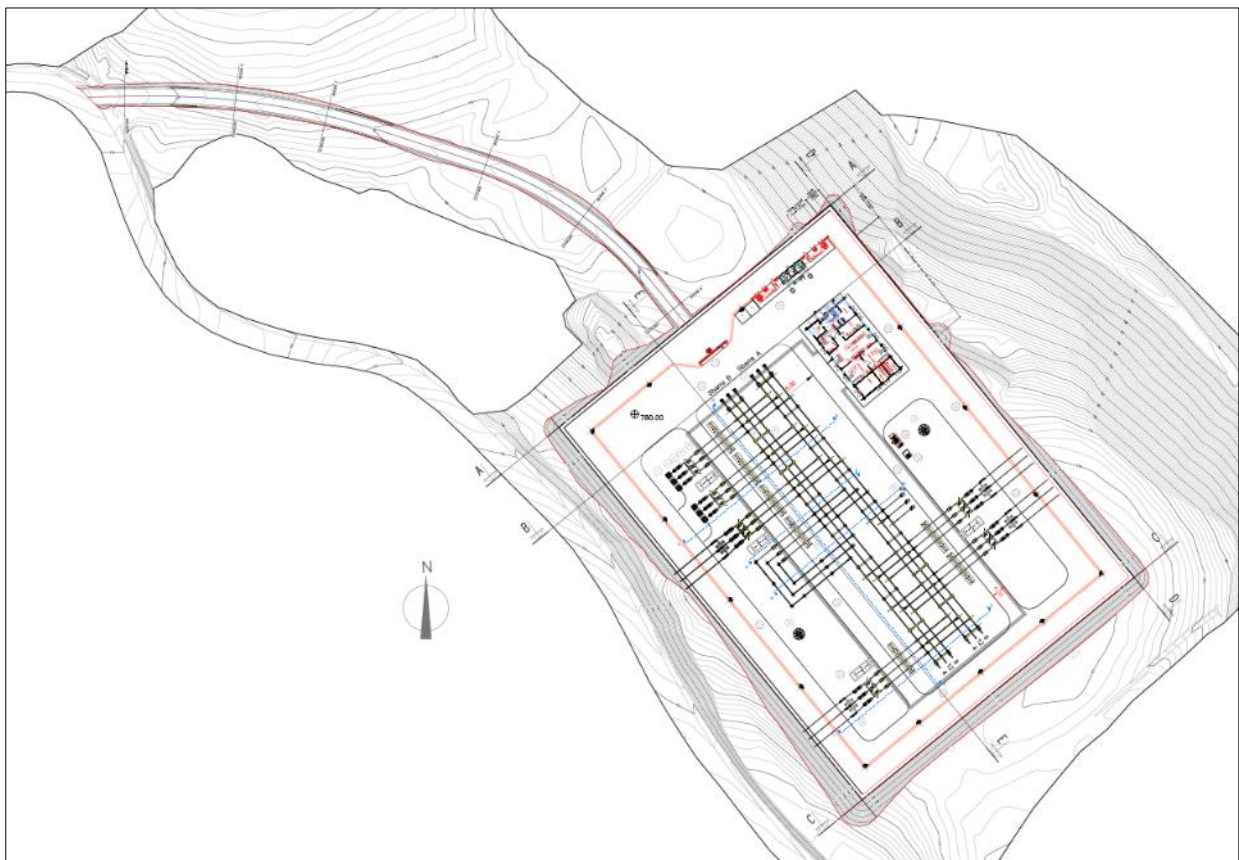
Planimetria della nuova stazione elettrica
